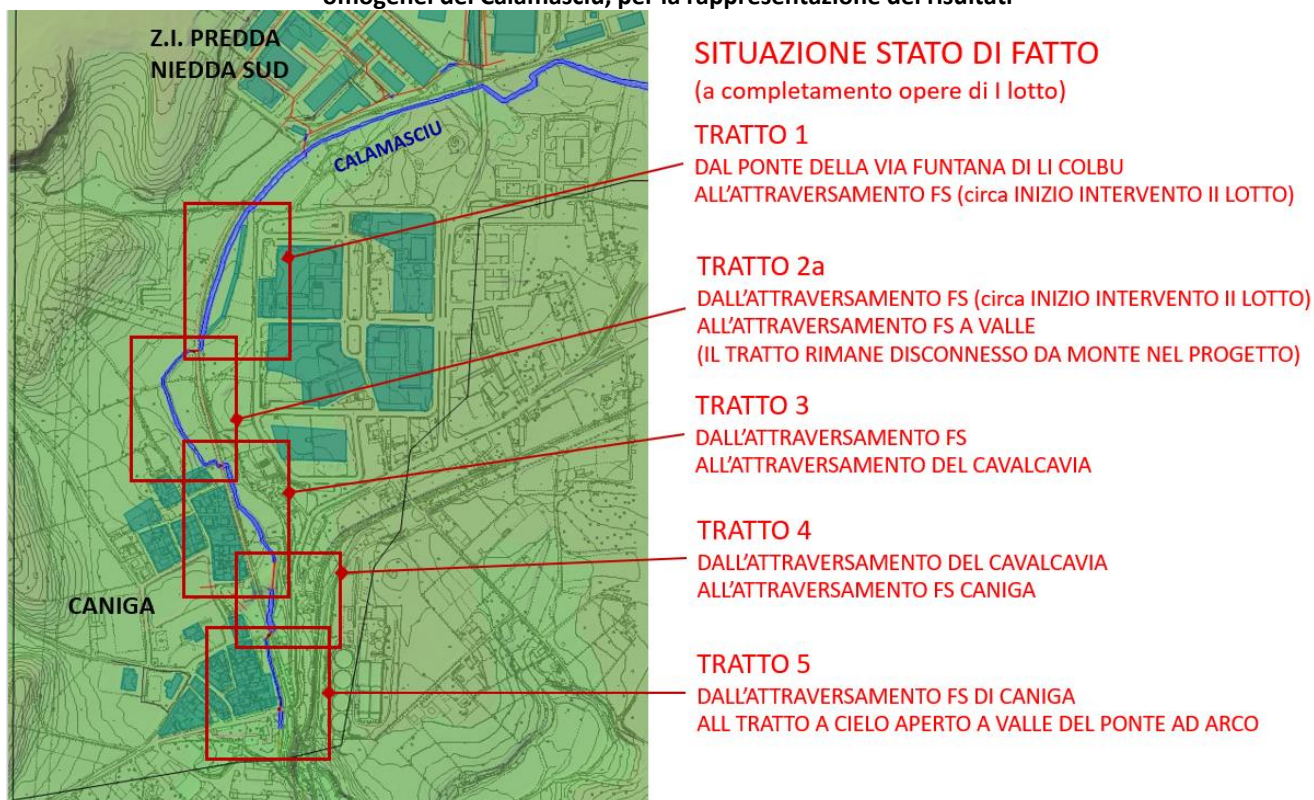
Situazione Ante Operam. Planimetria con evidenziazione Tratto 1 Calamasciu
